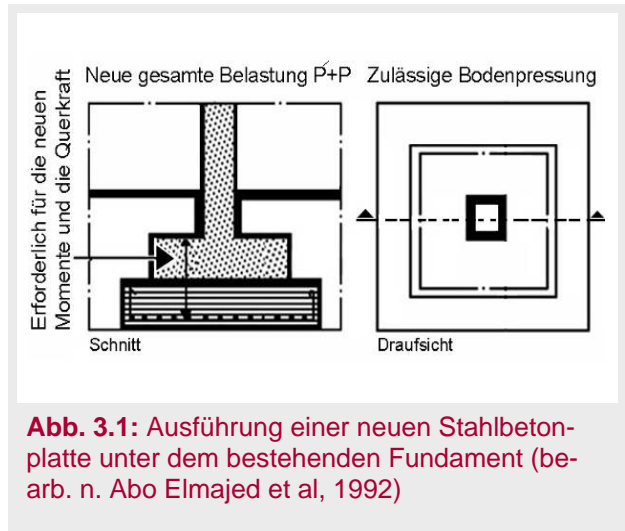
Ausführung einer neuen Stahlbetonplatte unter dem bestehenden Fundament (bearb. n. Abo Elmajed et al, 1992)
